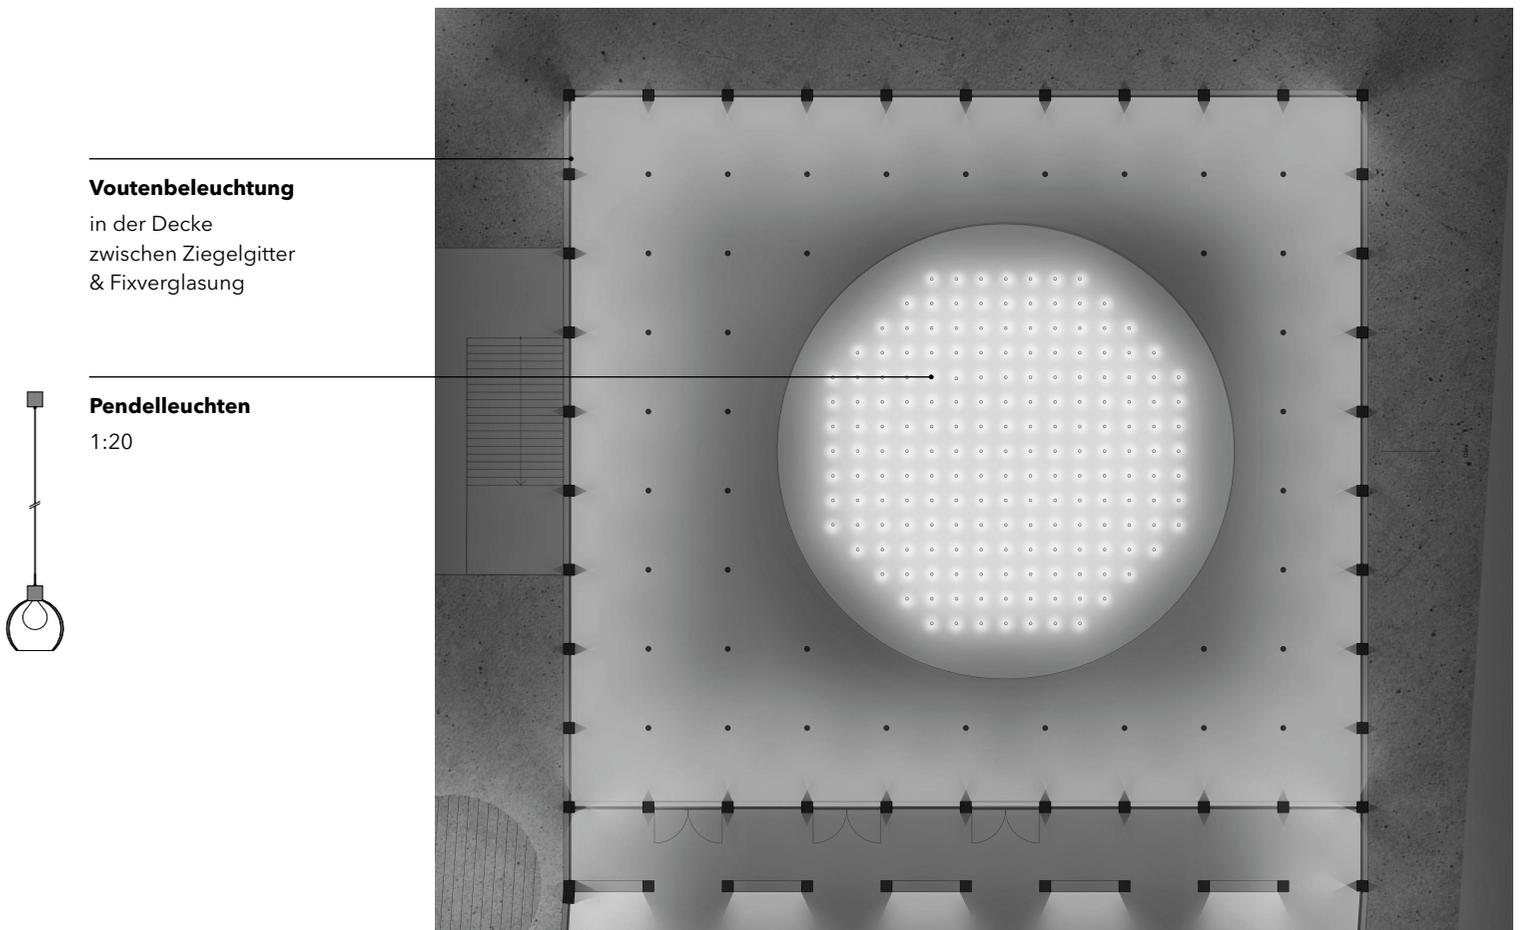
Lichtkonzept Grundriss Ebene 5 | 1:300
